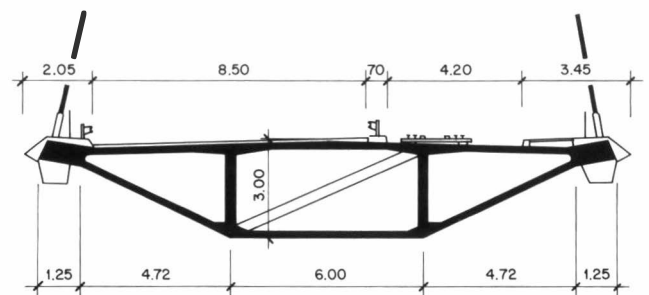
Querschnitt der Hauptstrombrücke (Masse in m) – Coupe en travers du pont principal (dimensions en m) – Section of the mainstream bridge (Dimensions in m) –
